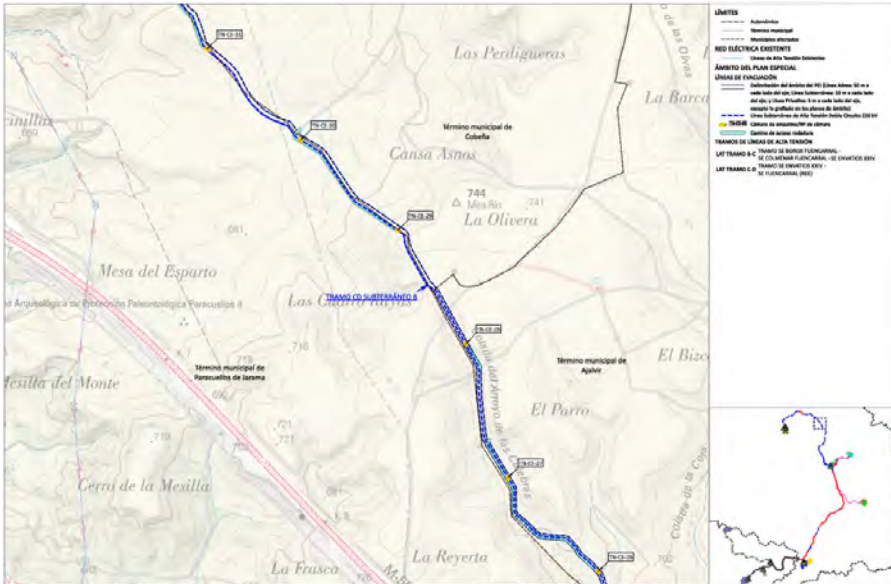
Plano de Ordenación O2.5.8. Planta por tramos. LASA Promotores Nudo Fuencarral Tramo C-D. Este documento es copia original firmado. Se han ocultado datos personales en aplicación de la normativa vigente
